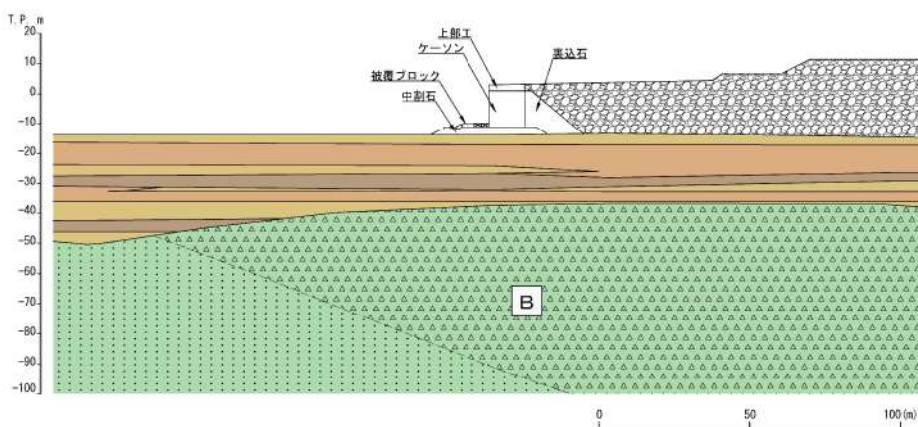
c.b-13 地質断面図 (E-E' 断面)
